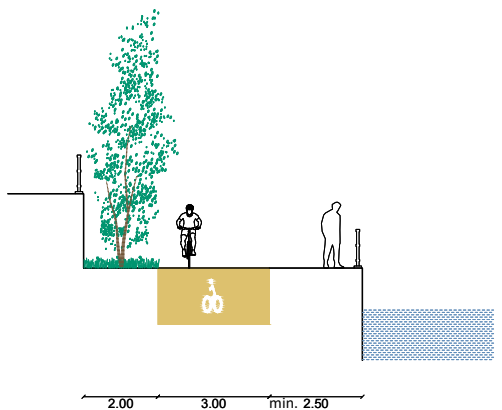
Largeur minimale pour une promenade piétonne et piste cyclable plantée
